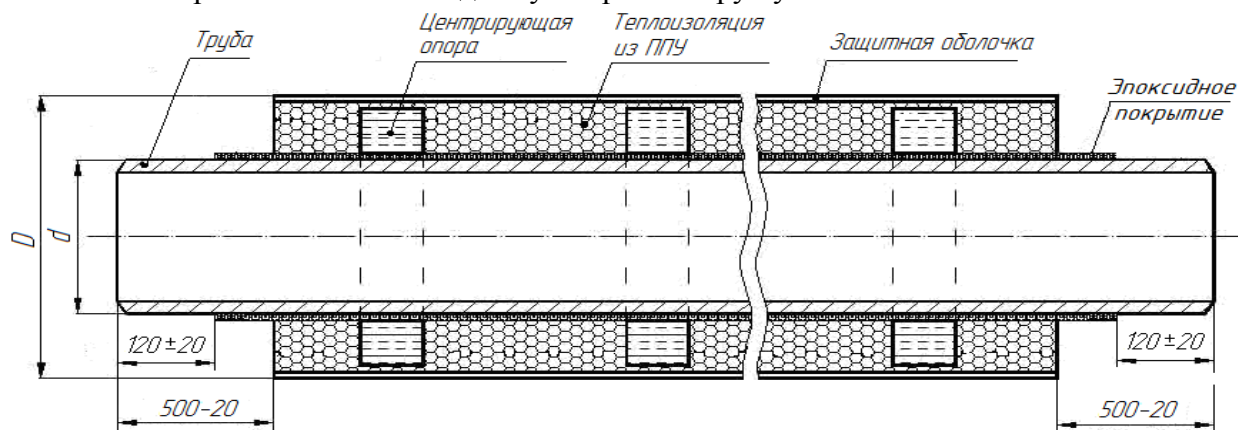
Конструкция трубы в теплоизоляции для надземной прокладки
